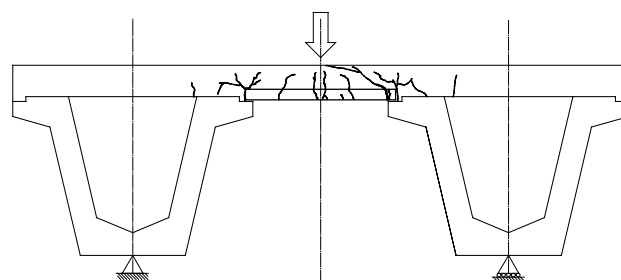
ひび割れ状況(静的・最大荷重時)
